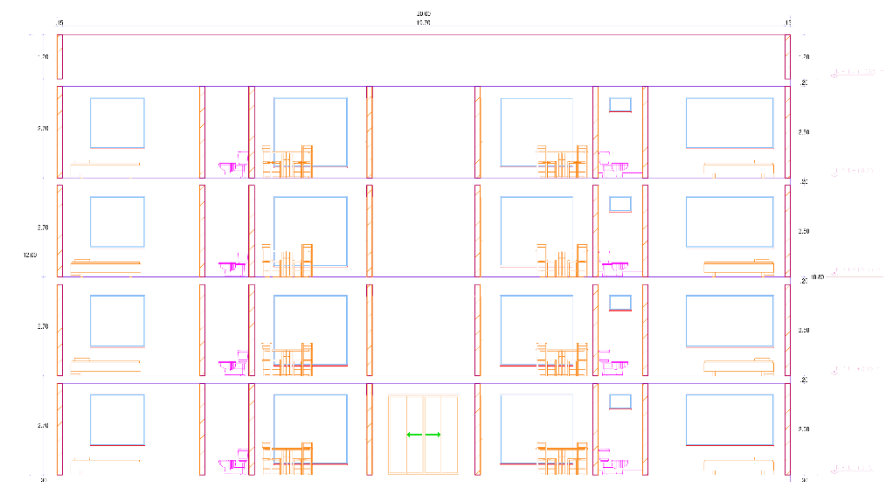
Plano Arquitectónico de Corte en Elevación B-B'.
